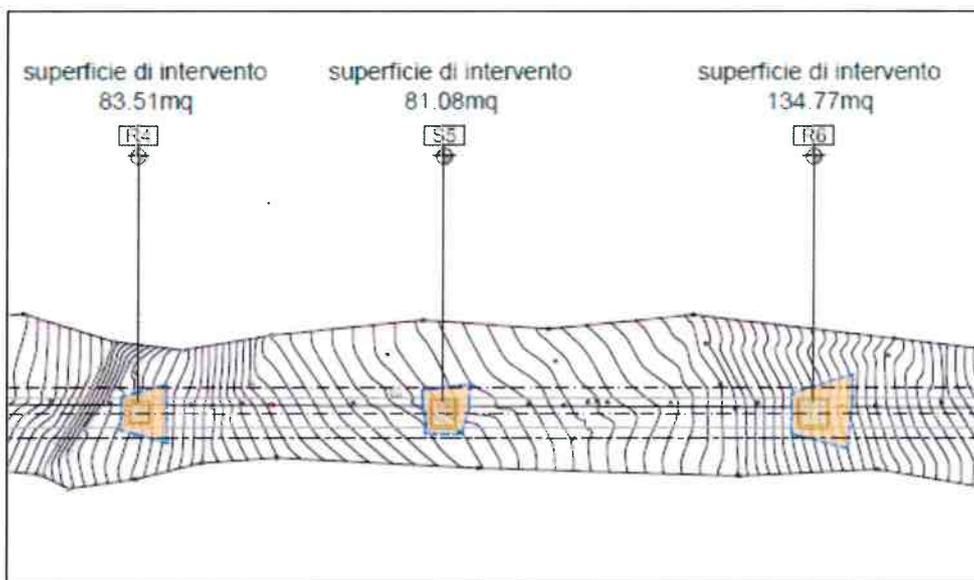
Stralcio planimetria di scavo linea seggiovia (da elaborato 6.2.3; si veda Fig. 14 per la legenda).
